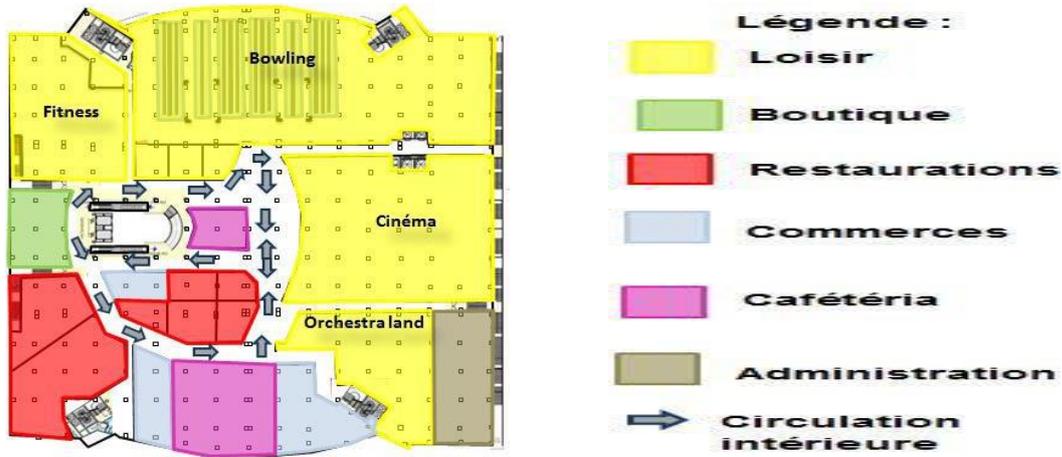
Vue en plan du 2eme niveau du centre commercial de Bâb Ezzouar.
